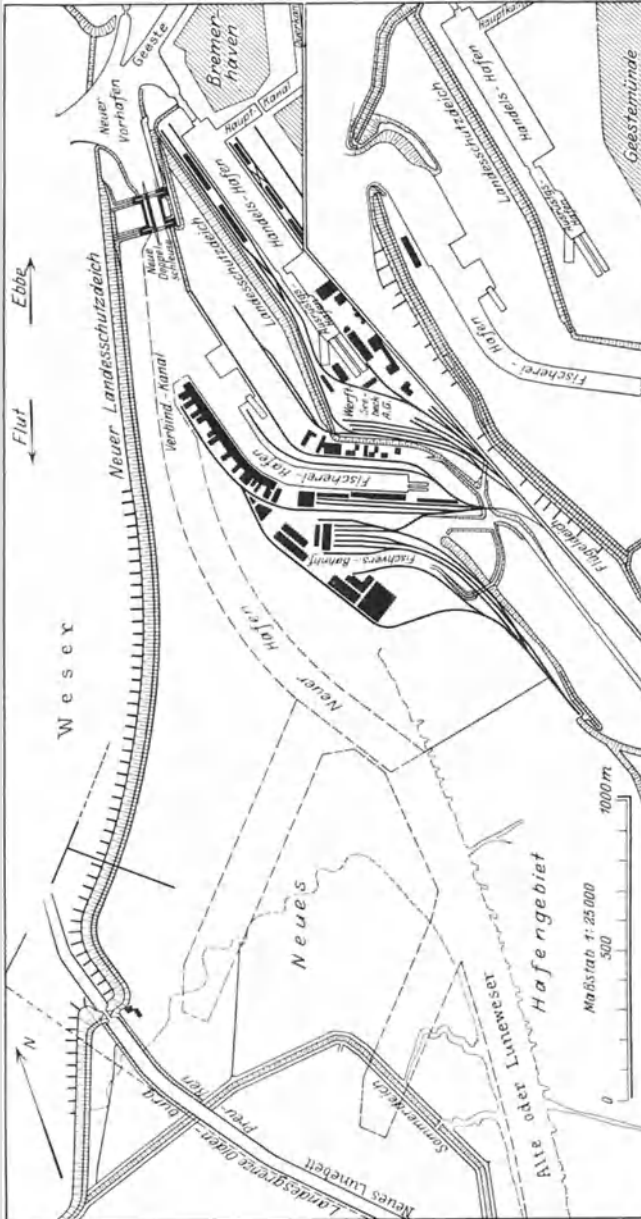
Erweiterte Hafenanlagen Wesermünde mit geplantem weiteren Ausbau. Alte Hafenanlagen. Hauptbedeutung als größter Fischereihafen Deutschlands. (Neue Geestemündung mit neuer Schleuse.) Rechts unten: Maßstab 1 : 25 000.
